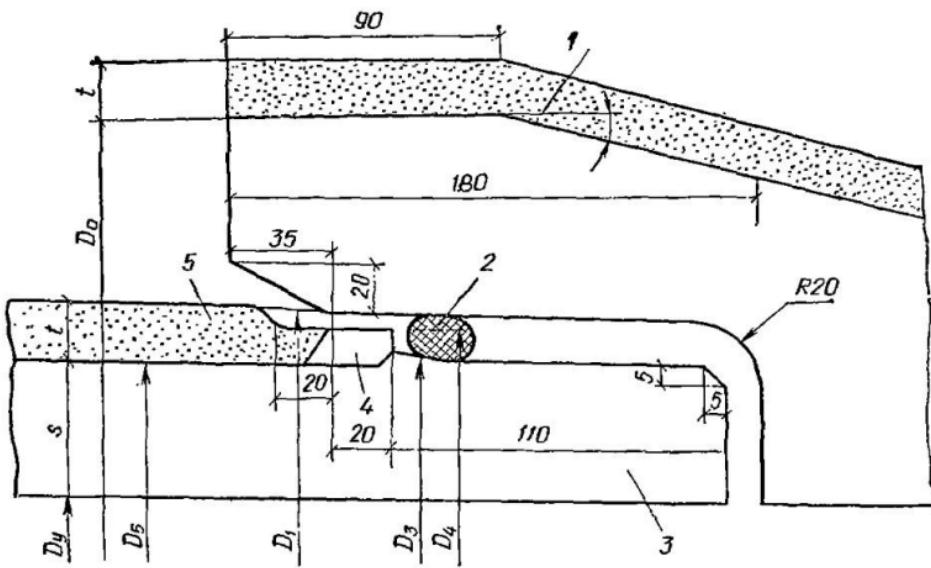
Стыковое соединение железобетонных предварительно напряженных труб, изготавливаемых методом центрифугирования
